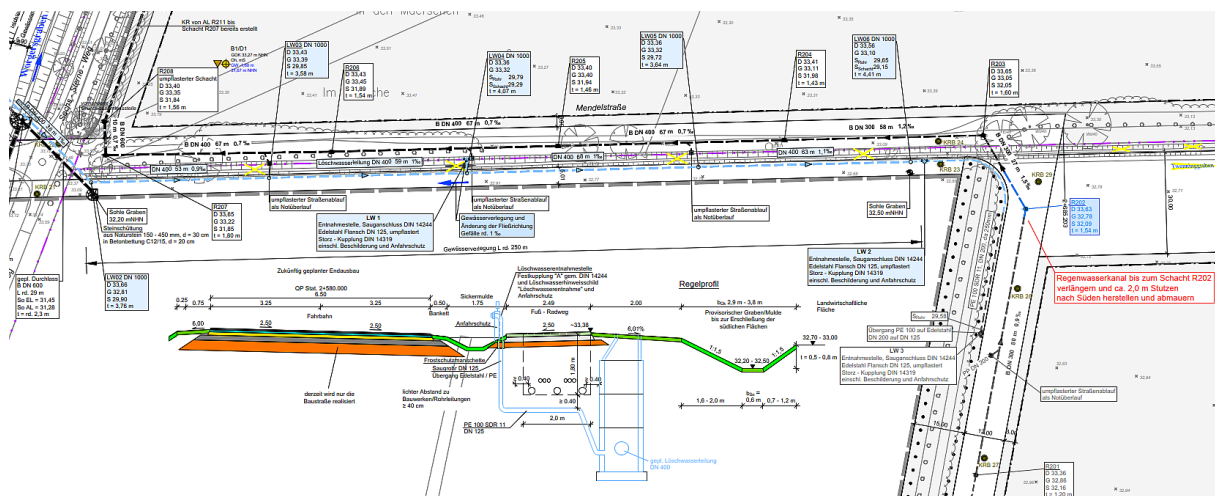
Lageplanausschnitt Erschließung B-Plan 148 (© 2022 IPW)
